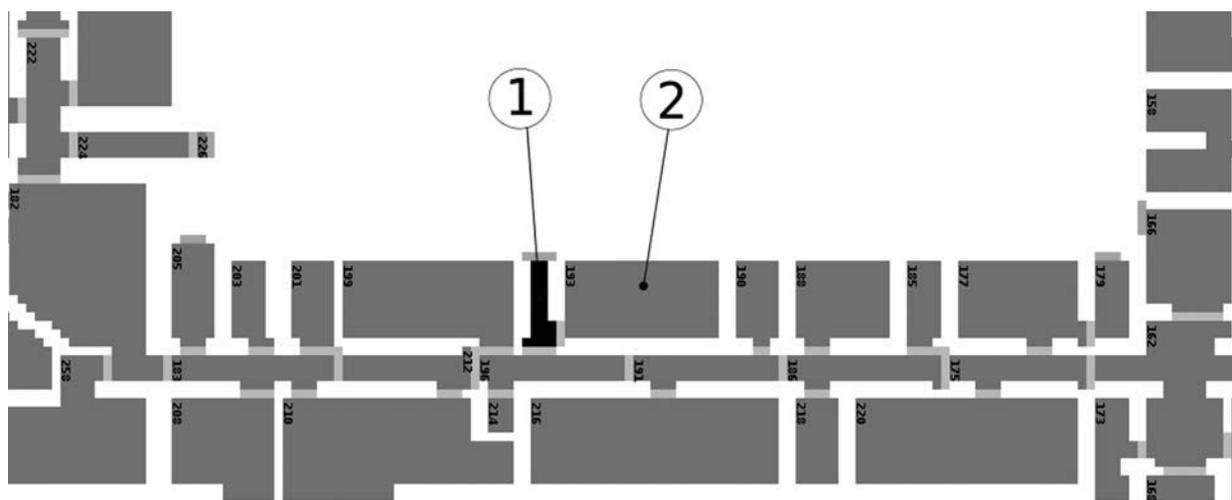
План здания с указанием помещений сценария: 1 — помещение с пожаром, 2 — исследуемое помещение
